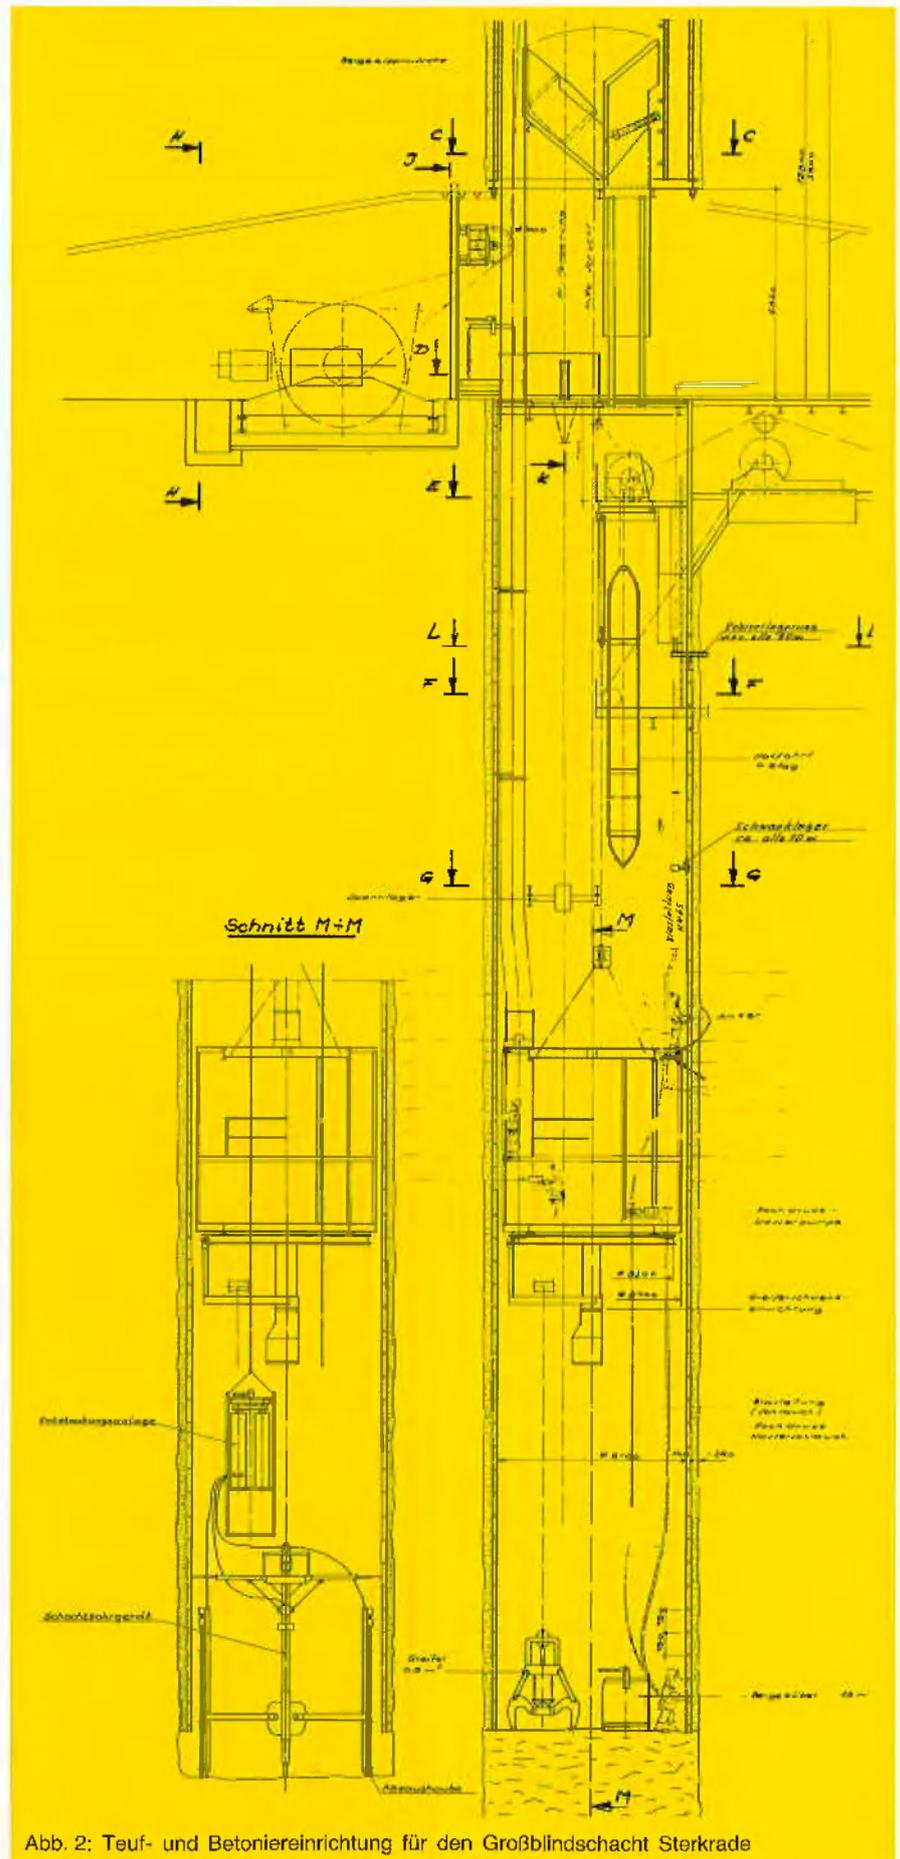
Teuf- und Betoniereinrichtung für den Großblindschacht Sterkrade
